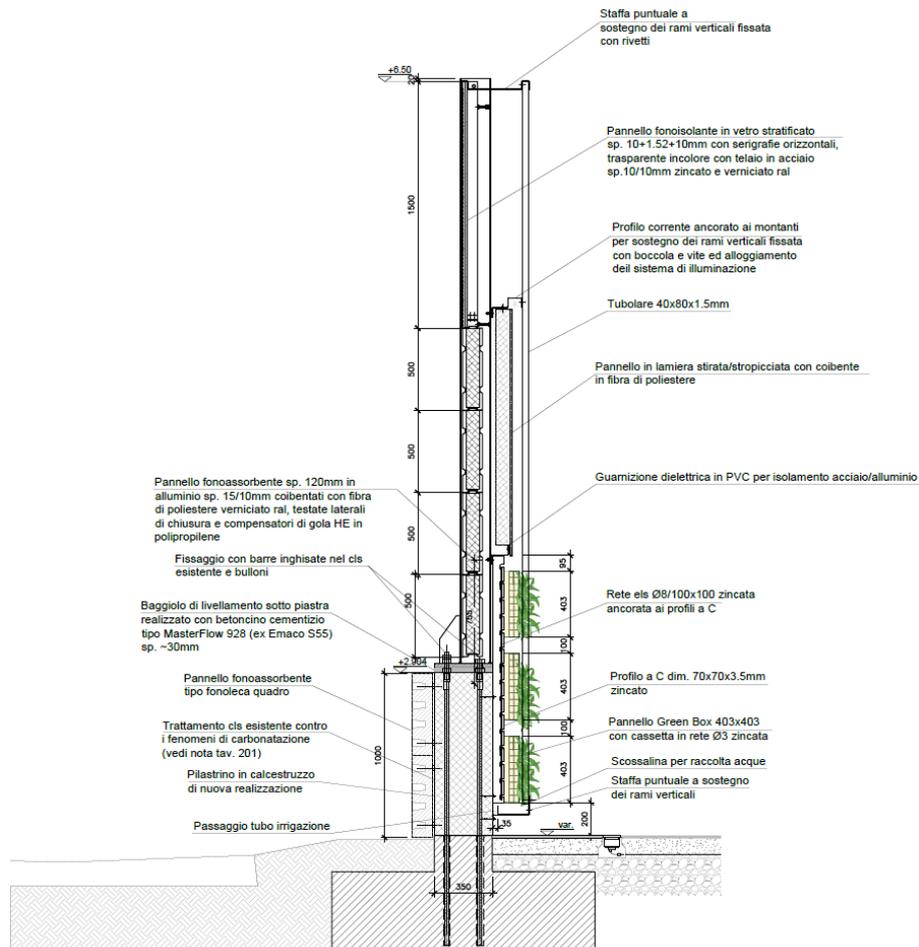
Progetto esecutivo - Protezione antifonica H=4,50 m, sezione tipo (A) – mista.
